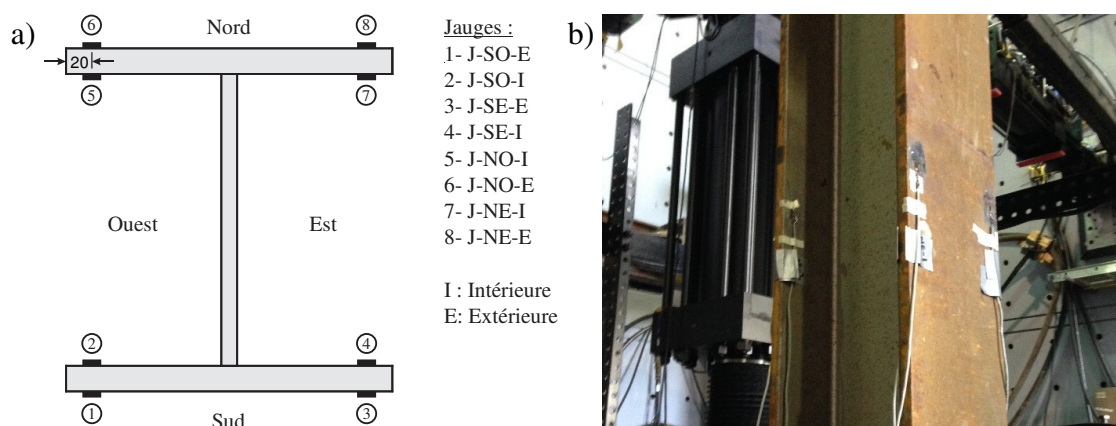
Positionnement des jauges : a) sur la section ; b) sur le poteau.
